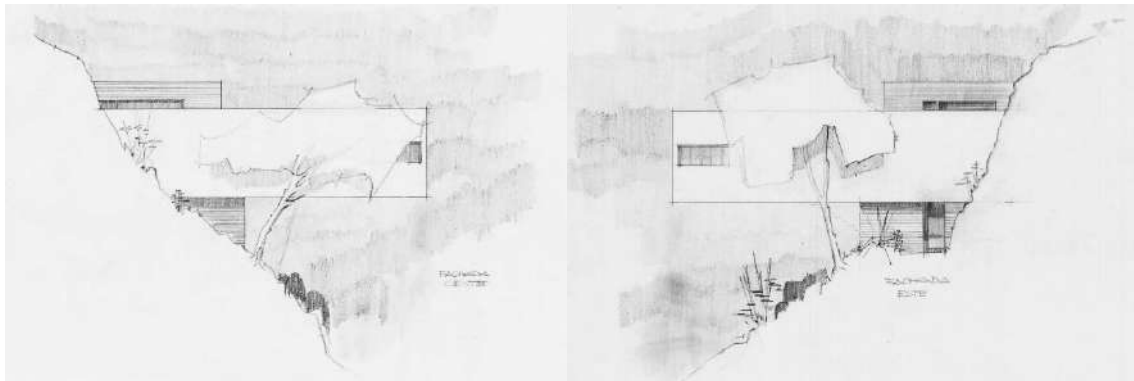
y 11. Alzados Oeste y Este. Fundación Bosch Aymerich.
